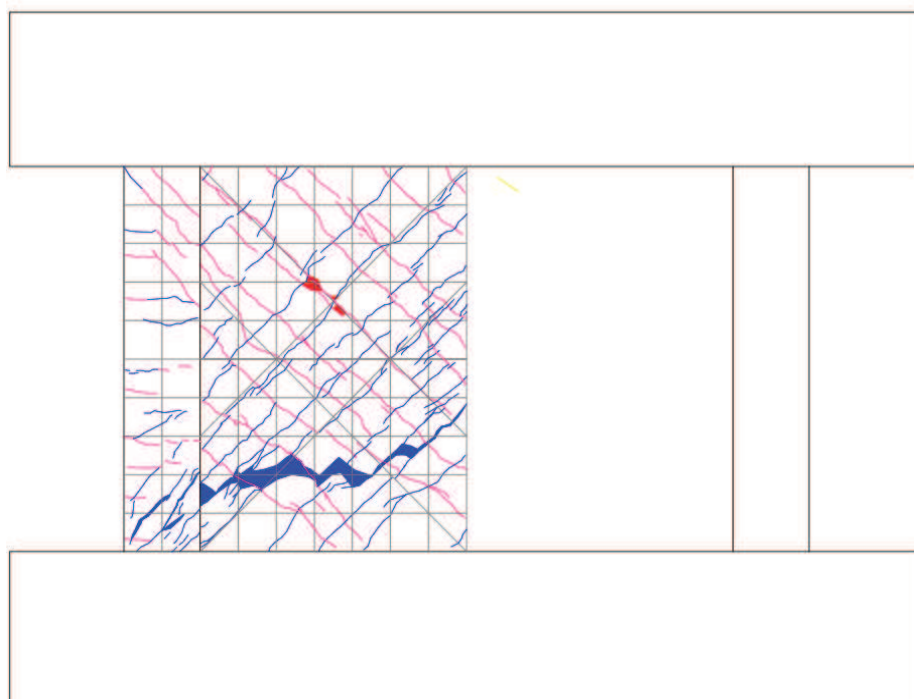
試験体 S-06-DIV 最終破壊時ひび割れ図
